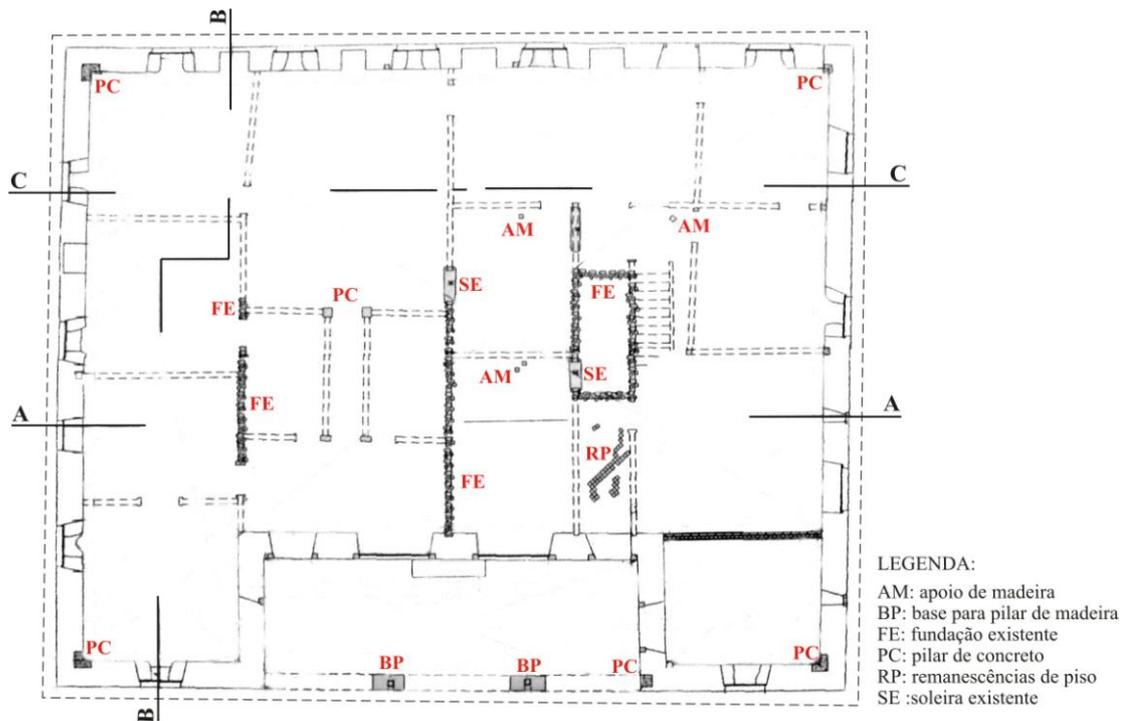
Foto digital da planta do levantamento de 1988.
